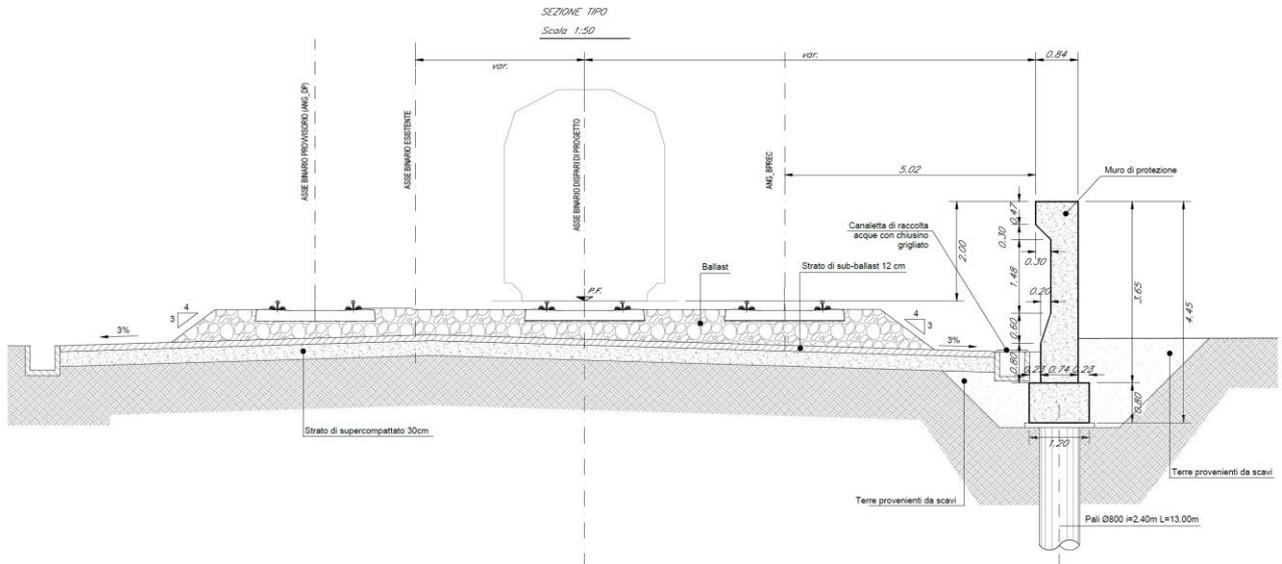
Muro di protezione lato BD dal km 30+745.6 al km 30+868.6- sezione tipo
